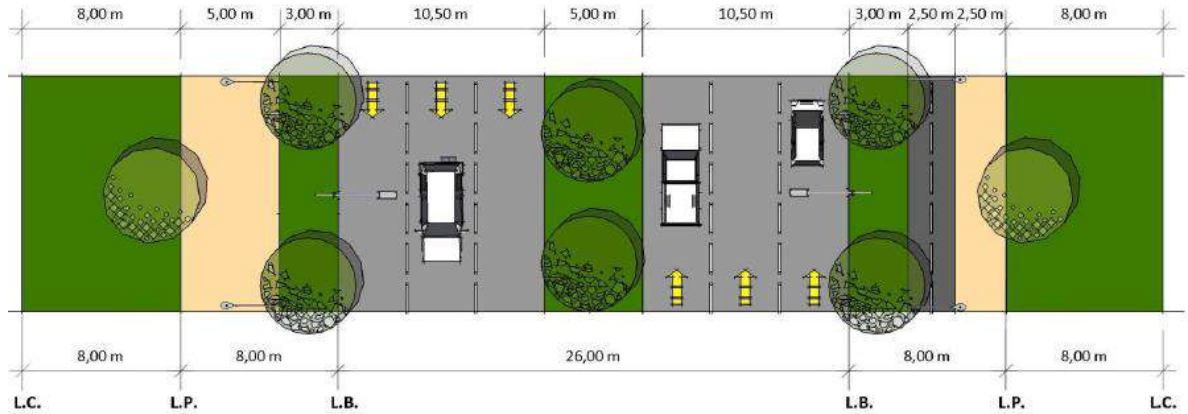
Perfil V-2. VÍA 40. VÍA ARTERIAL.
